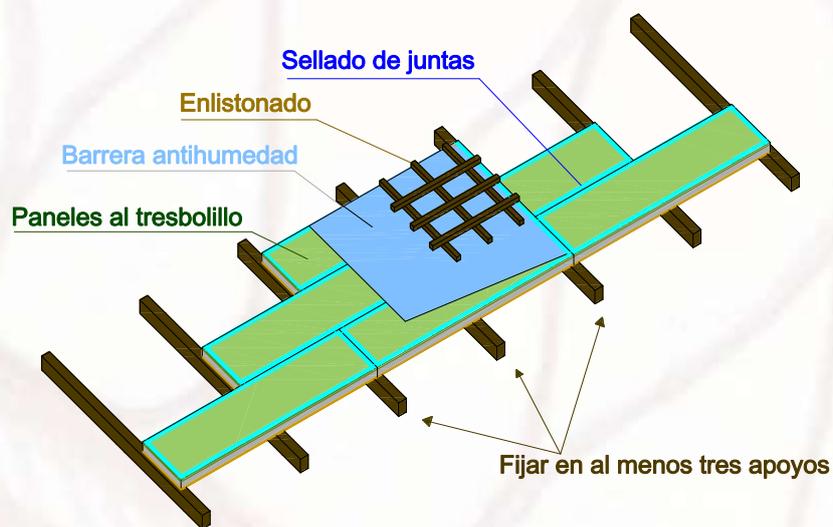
Elementos de una cubierta inclinada con panel sándwich de madera
